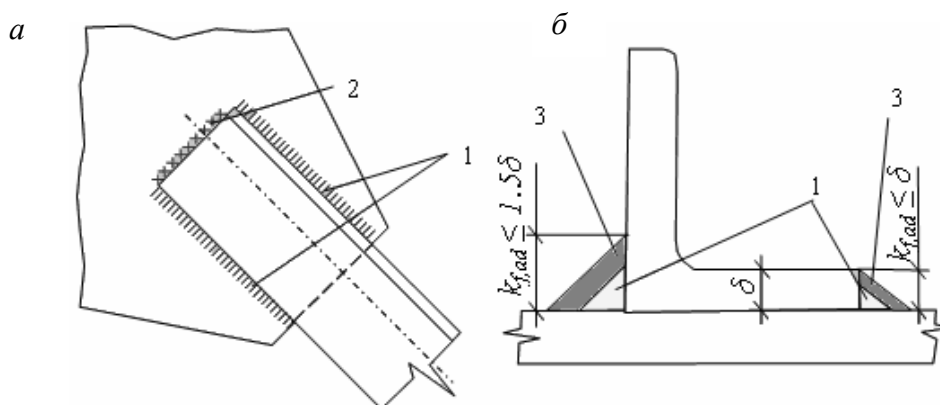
Усиление сварных швов: а – увеличением длины за счет наложения лобового шва; б – увеличением высоты катетов угловых швов: 1 – существующие швы, 2 – дополнительный лобовой шов, 3 – дополнительная наплавка
